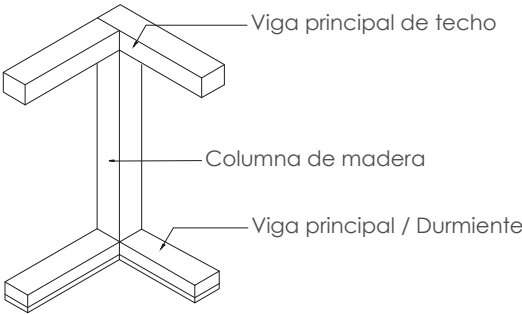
Detalle constructivo uniones con clavos y caja espiga
